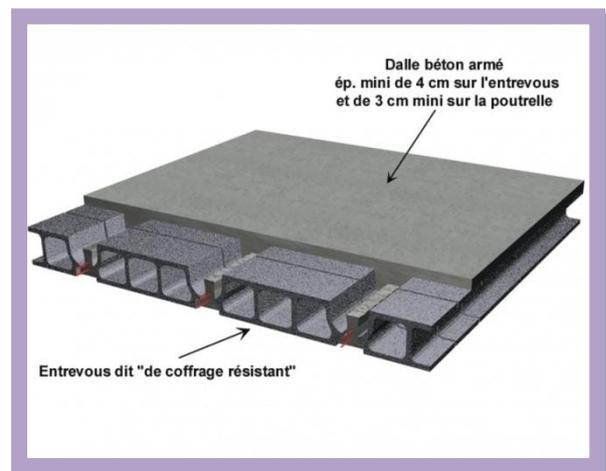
détail dalle en corps creux. source: <https://www.flickr.com/photos/63280529@N05/7589265670>
